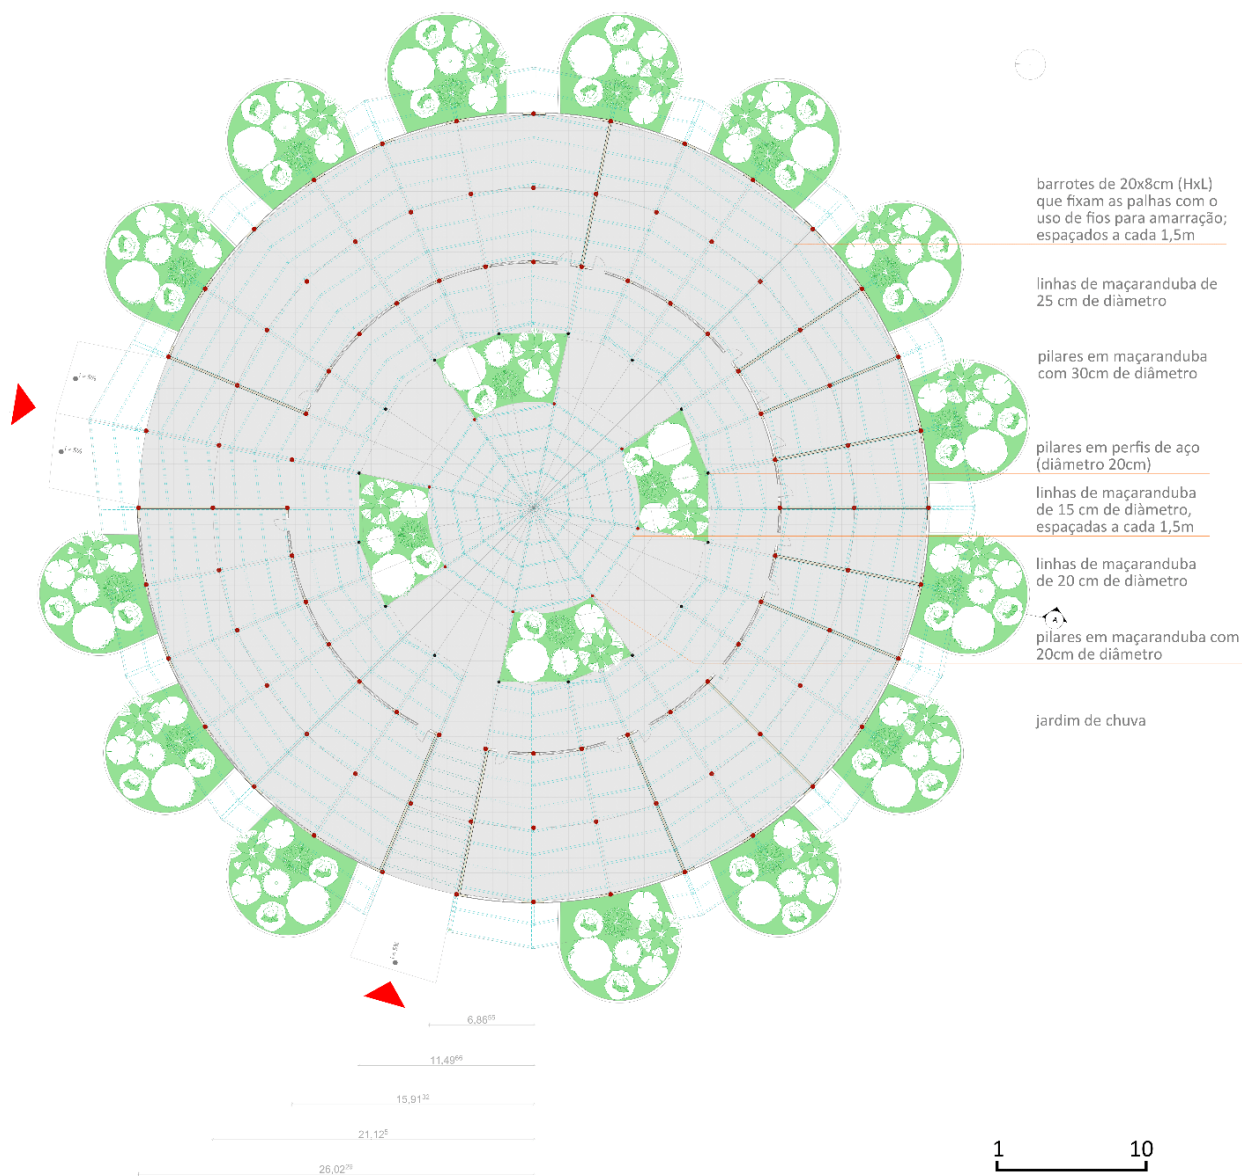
Planta de estrutura da coberta. Elaborada pela autora
